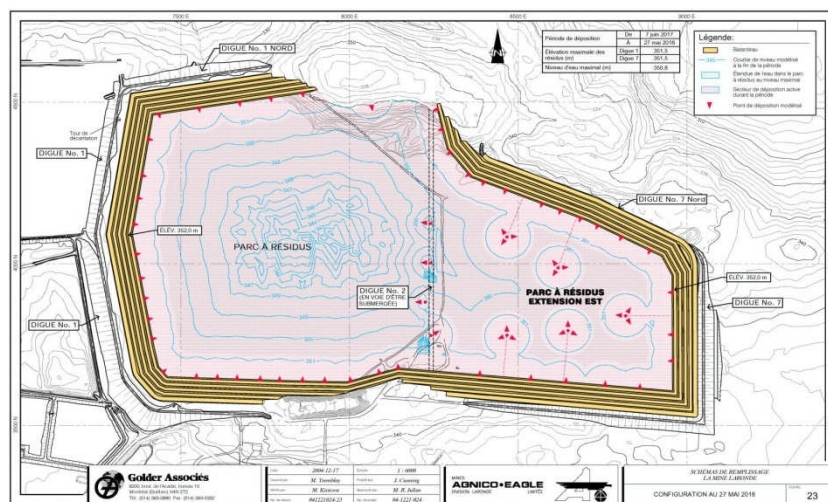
Vue en plan finale, parc à l'élévation de 352,0 m
